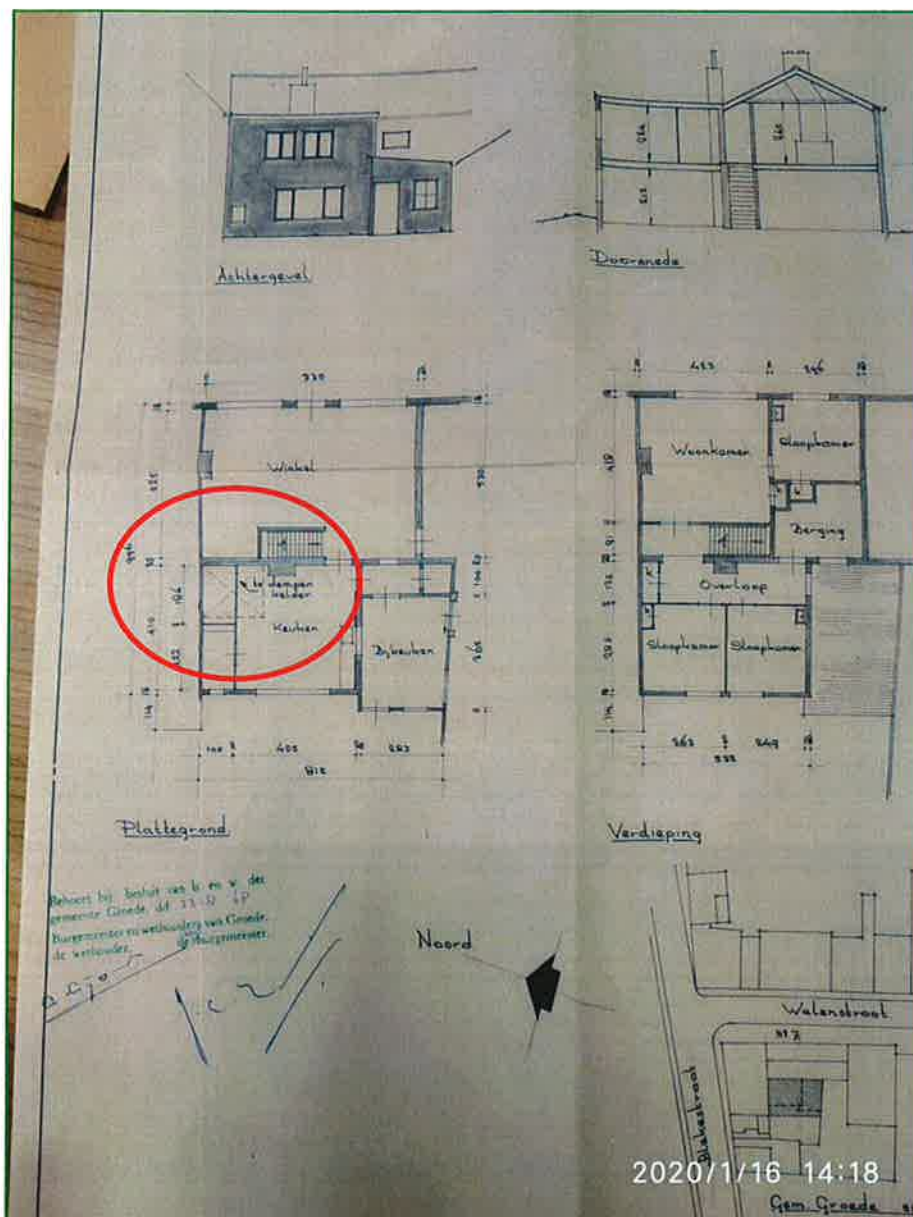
Plantekening met rond 1968 te dempen kelder (volstorten met beton)
